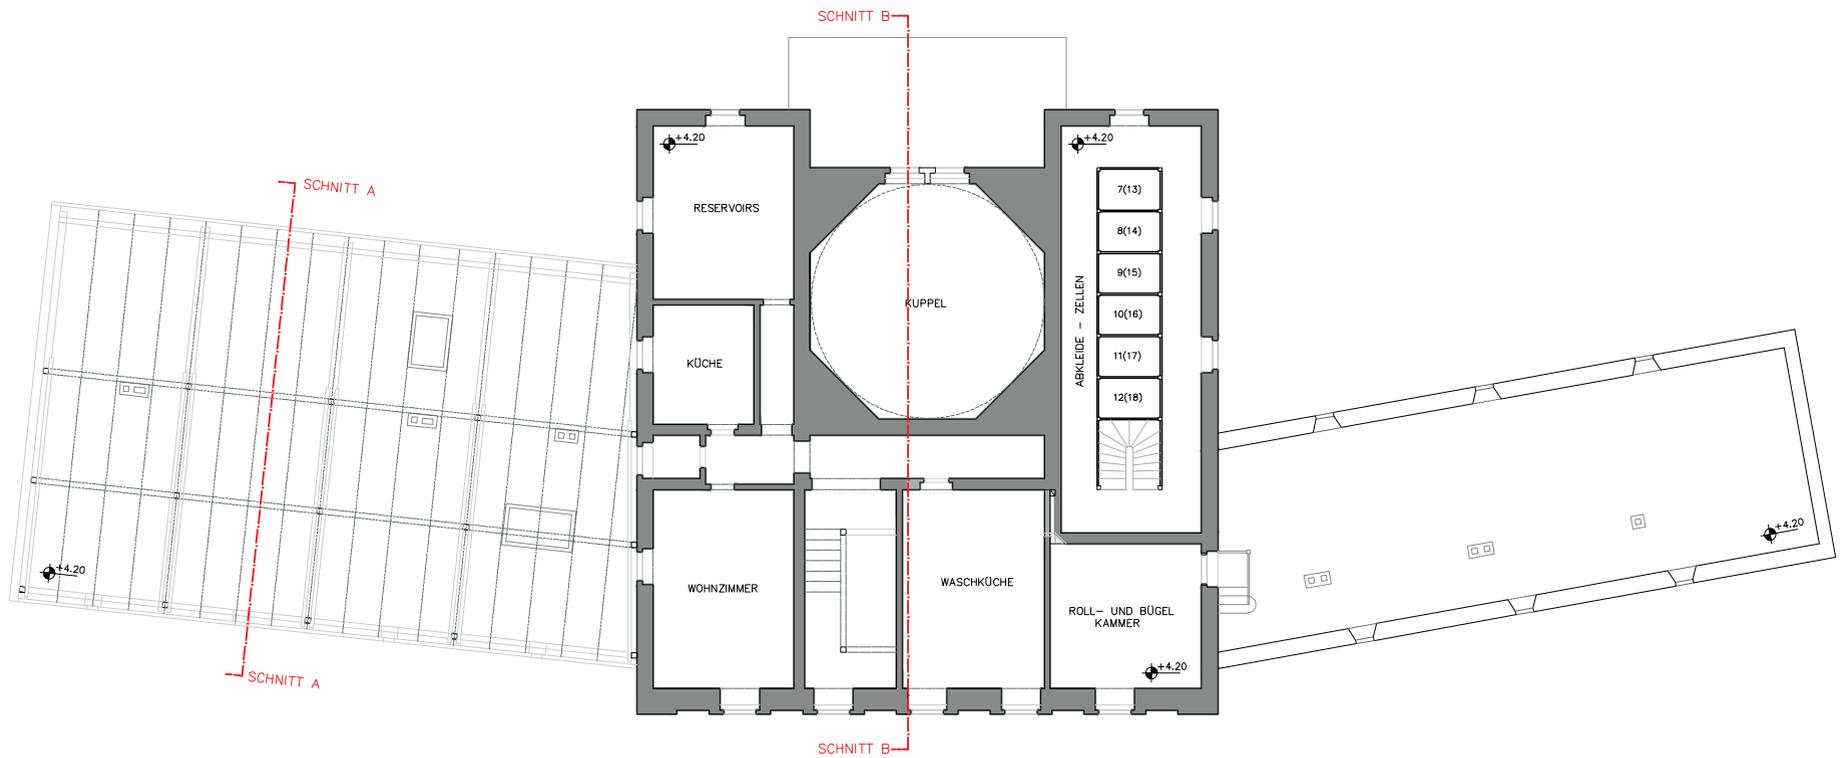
Grundriss des alten Gebäudes 1.OG M 1:200
